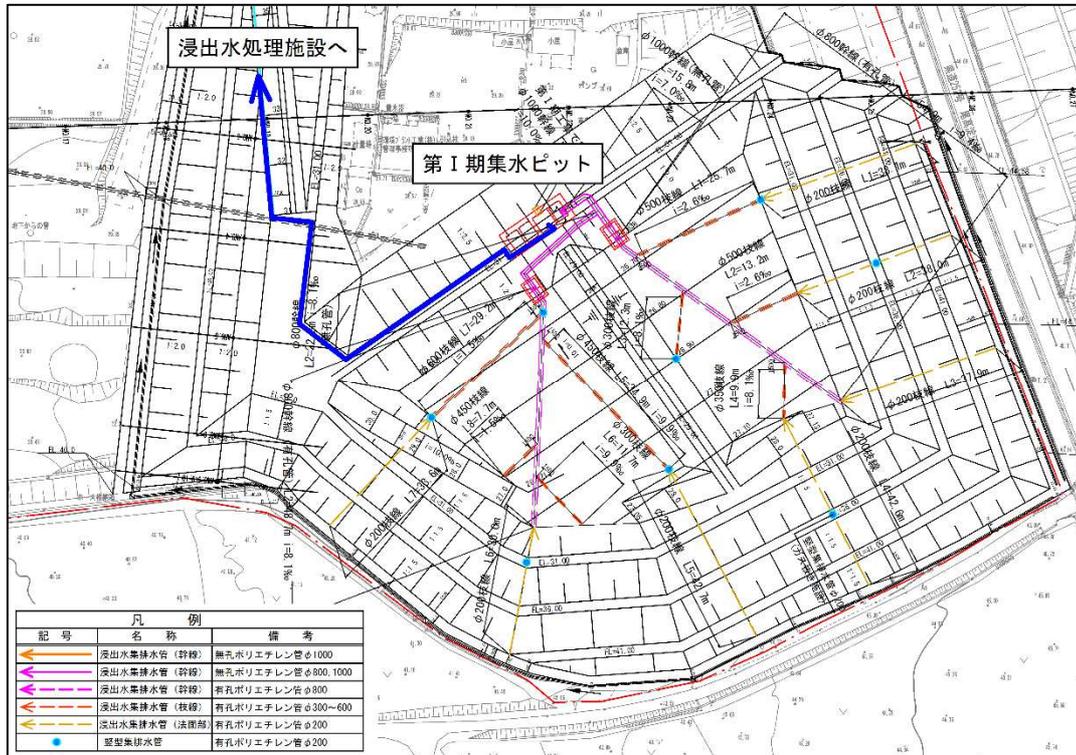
浸出水集排水施設配置計画平面図 (第Ⅰ期)
